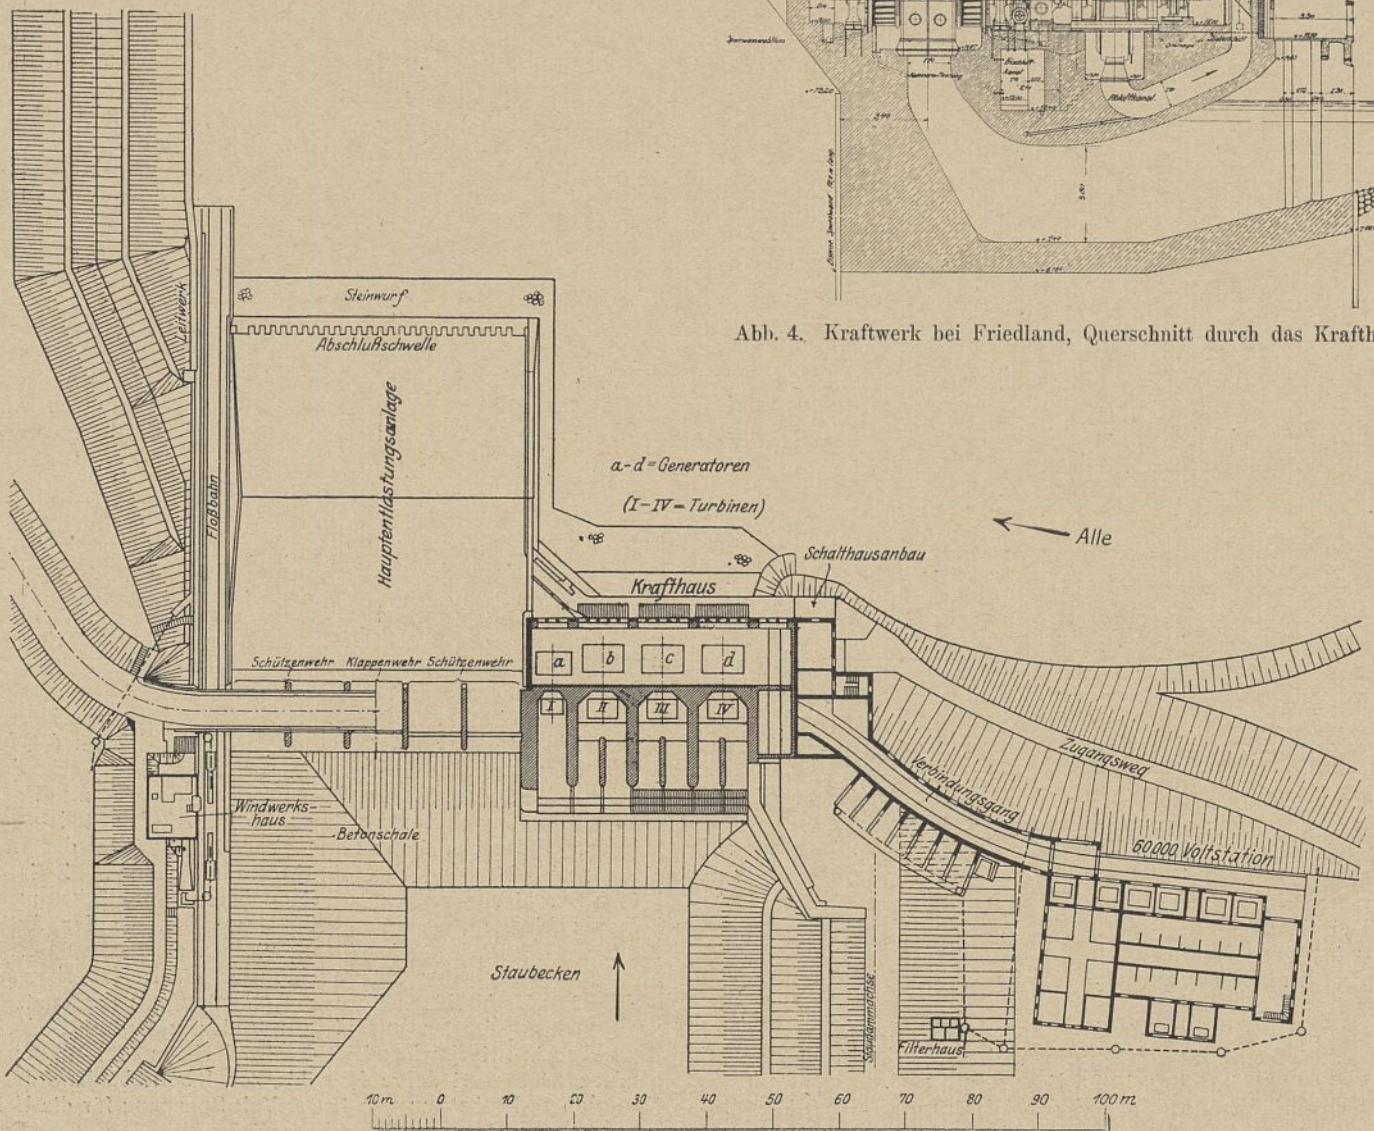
Kraftwerk bei Friedland, Grundriß der Anlage.
